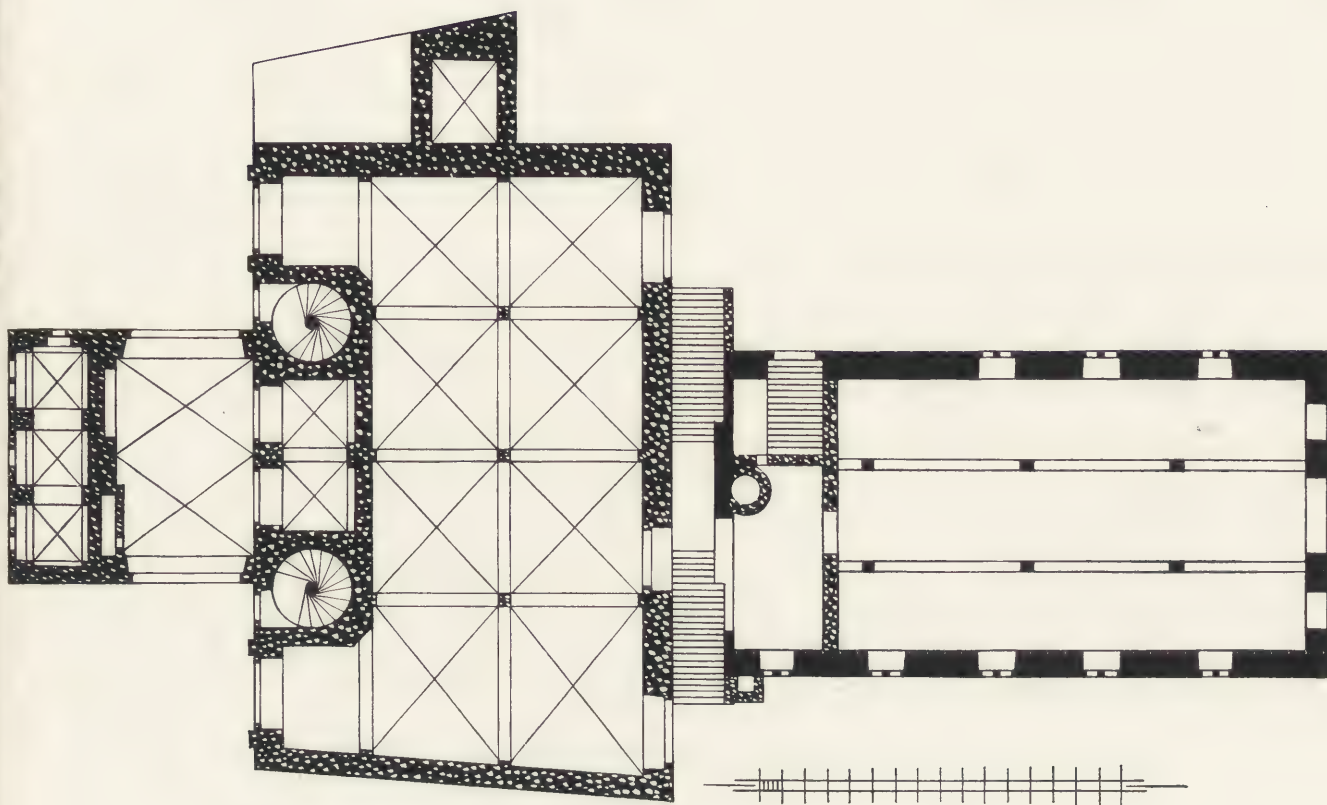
Rathaus zu Schweinfurt. Grundriß des Erdgeschosses.
